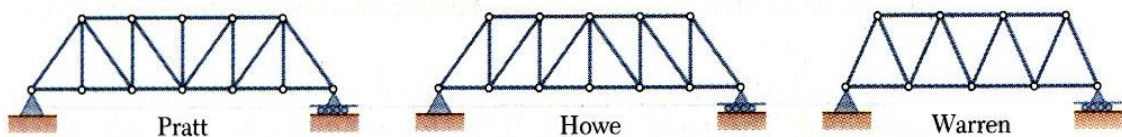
Exemple de poutres ( ou de fermes) trapézoïdales en treillis
